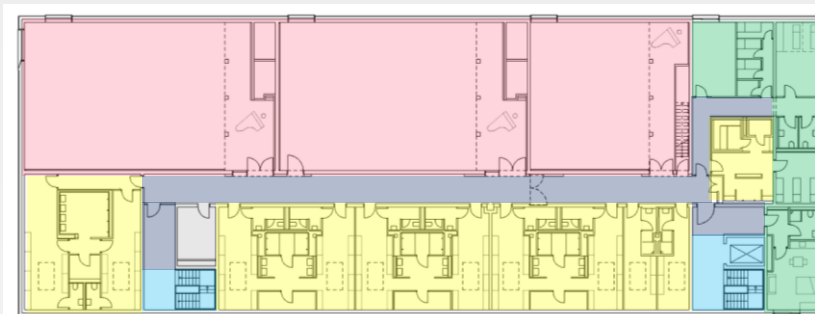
Planta Baixa do 2º pavimento (GMP ARCHITEKTEN, 2019).
